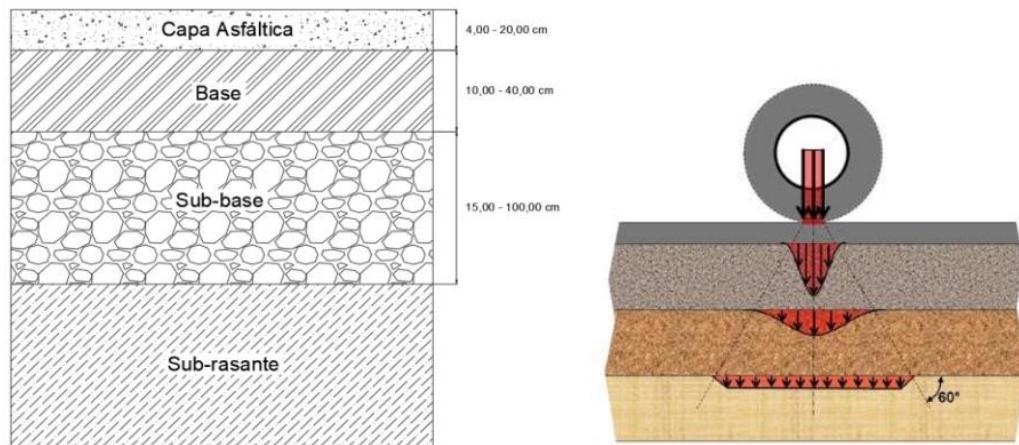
A. Estructura del pavimento flexible. B. Transmisión de cargas en pavimentos flexibles.
